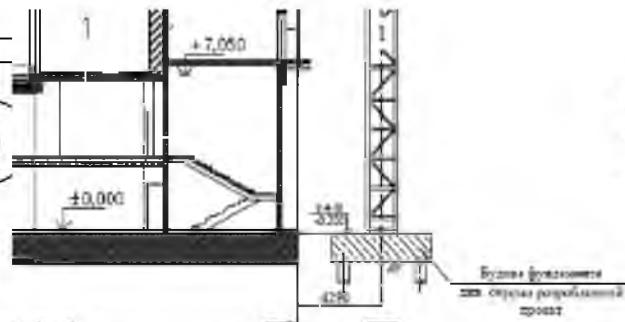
Влаштування окремого фундаменту під самонарацтовальний баштовий кран Liebherr 132 EC
